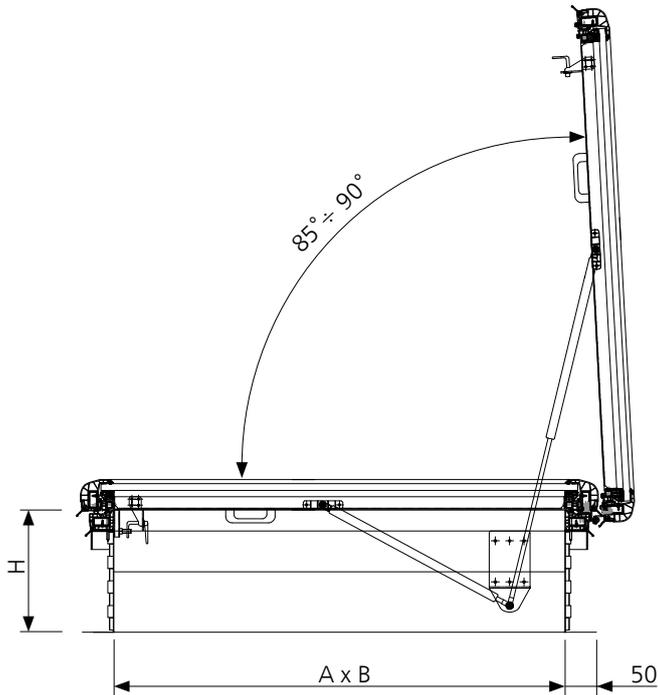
Schnitt B-B durch einen Dachausstieg mcr ULTRA THERM Typ C in geöffneter Position, Maße in [mm]
